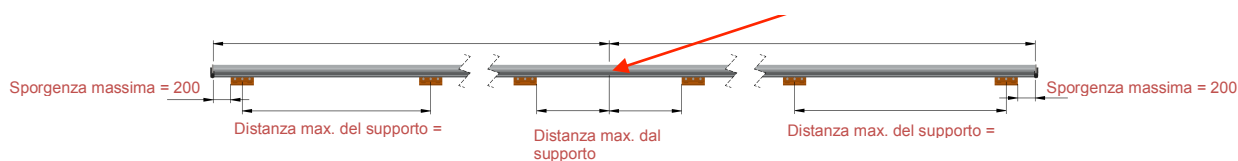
Variante montaggio SR-105 distante max. 500 mm dal collegamento
